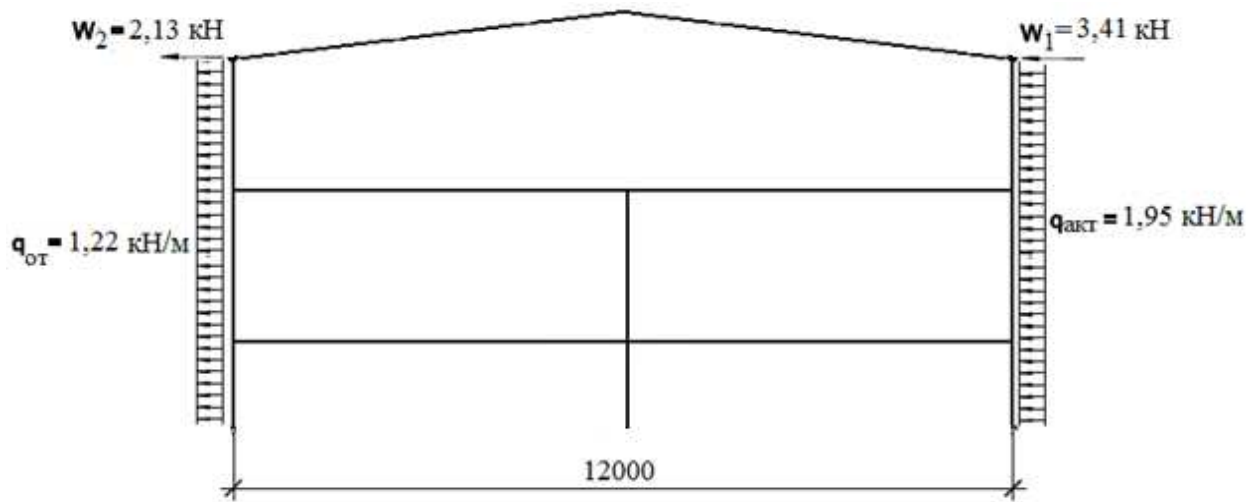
Схема загрузки от ветровой нагрузки справа здания
